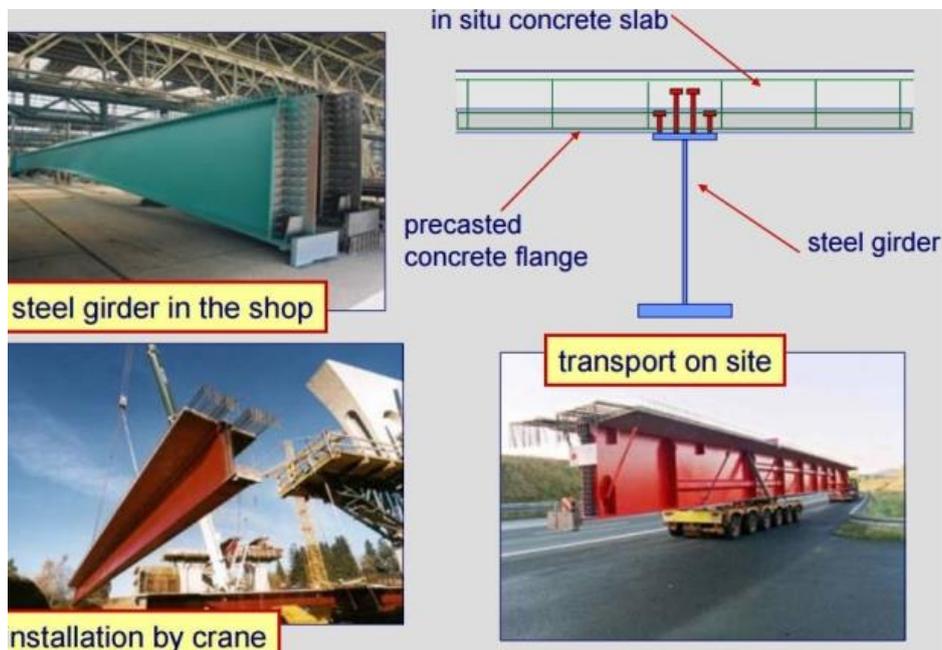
Сборные комбинированные балки сталежелезобетонного пролетного строения [1]
